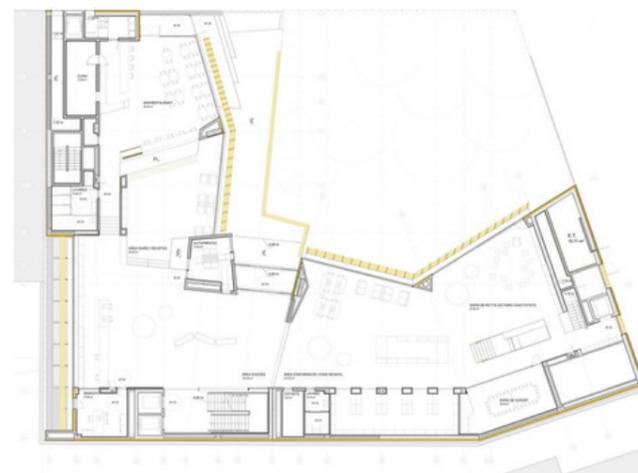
Planta Baja Biblioteca Pilarín Bayés
